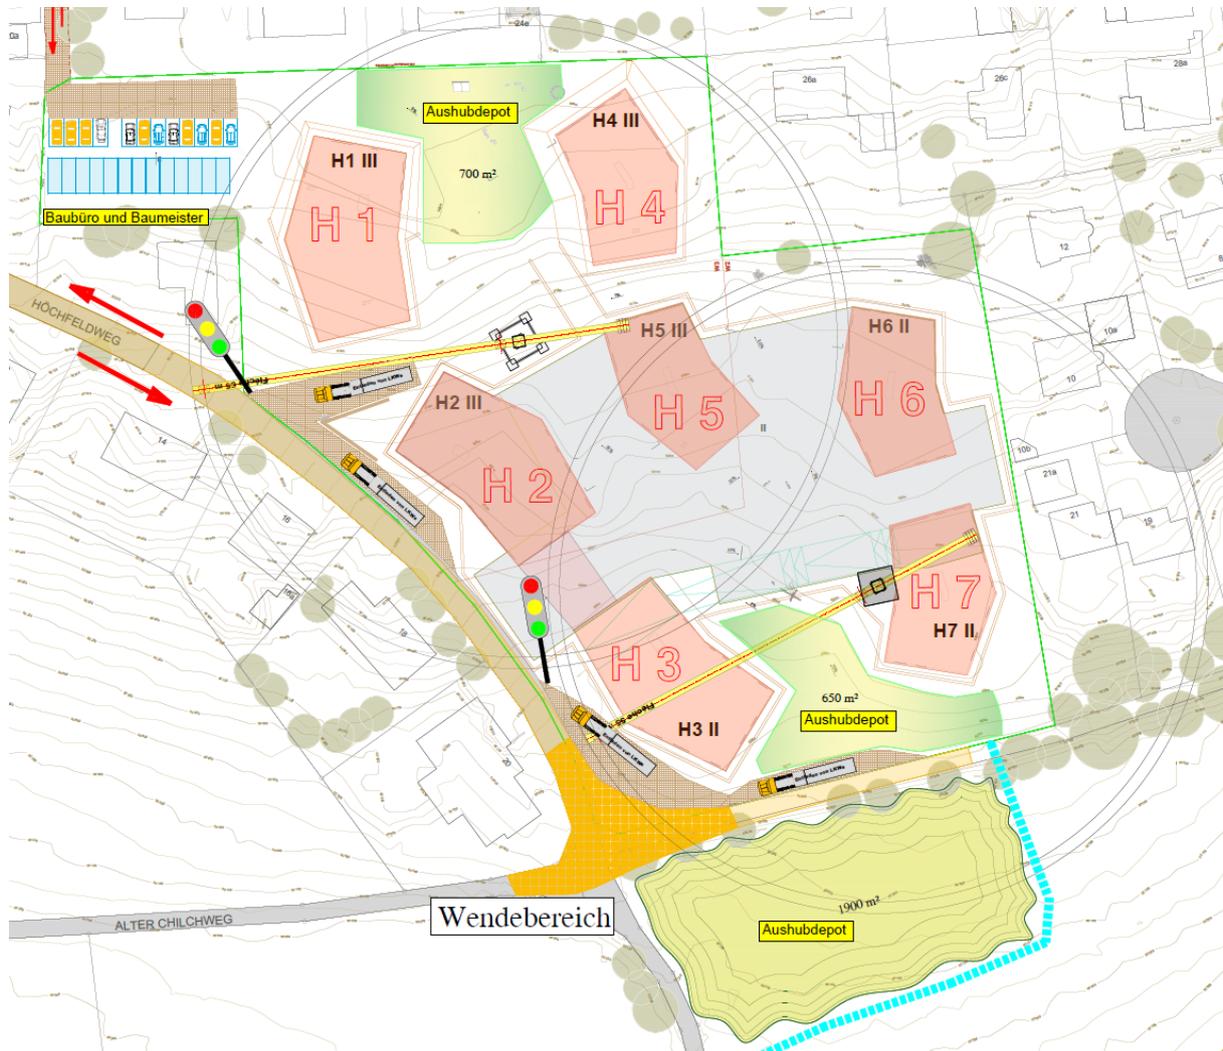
Ausschnitt Baustellen-Installationsplan mit Aushub-Lagerungen
